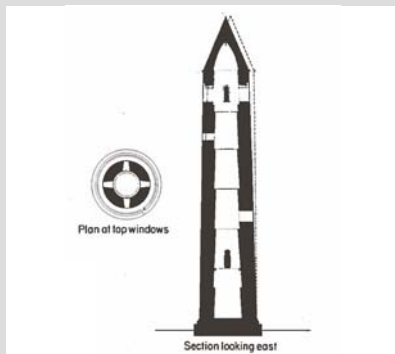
Plan, coupe Tour Timahoe, Co. Leix
